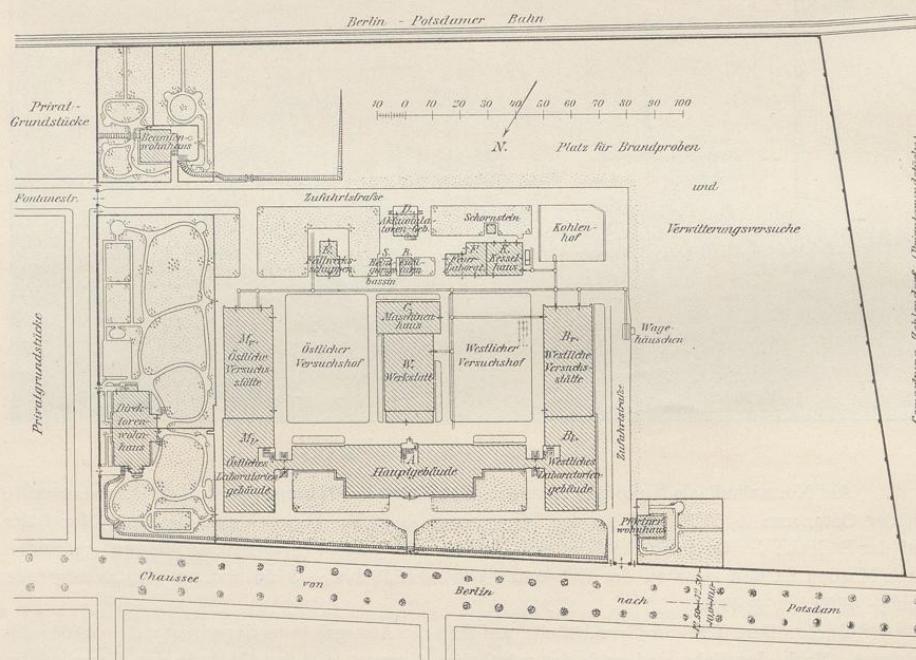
Lageplan des Grundstücks mit den Gebäuden und Straßen.
